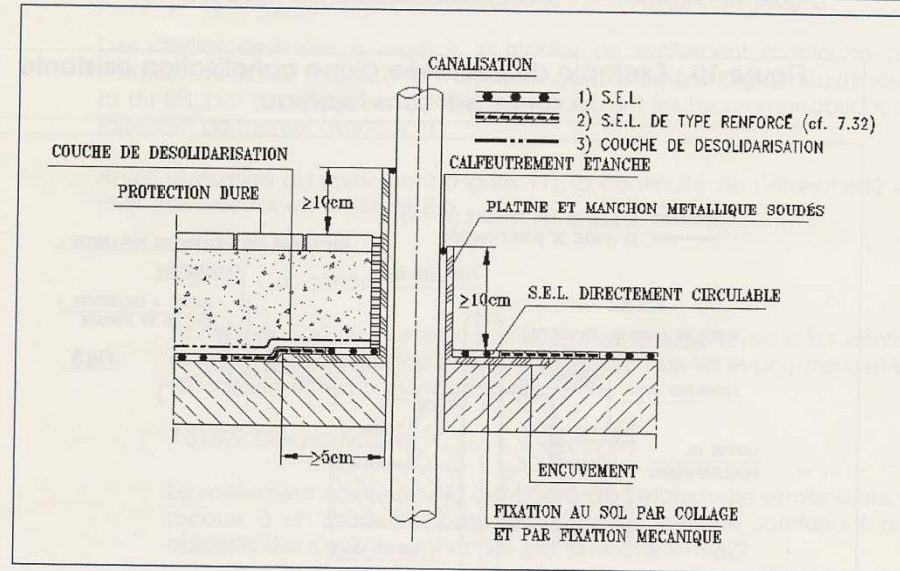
Exemple de traversée d'une canalisation sur massif avec fourreau
